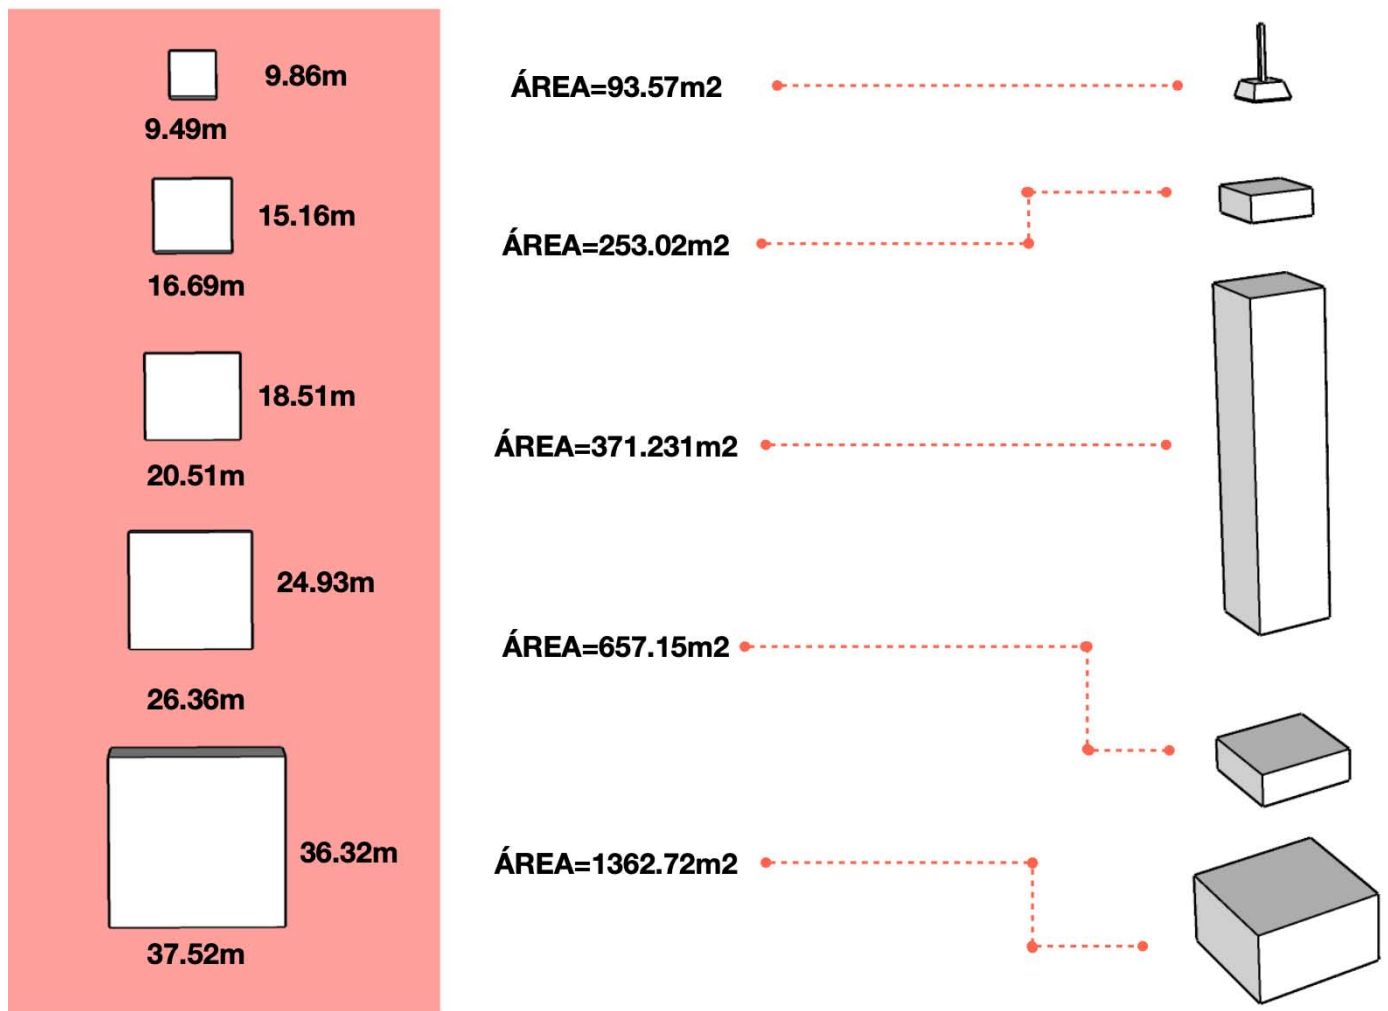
Cálculo general de techos Torre Latinoamericana. Elaboración propia.
